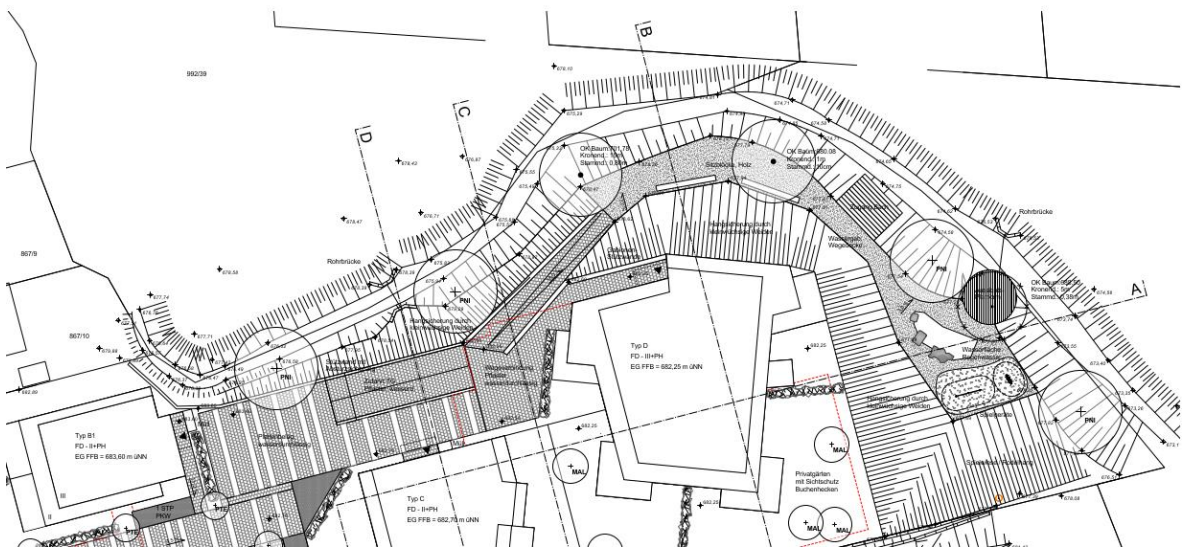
Ausschnitt Freiflächenplan, o.M.
